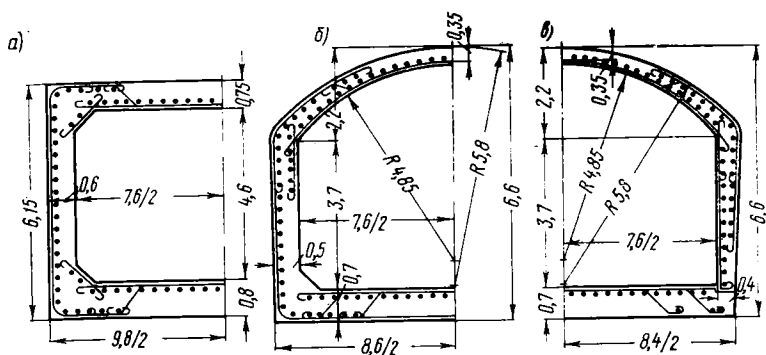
Конструкции тоннеля в виде железобетонной рамы
